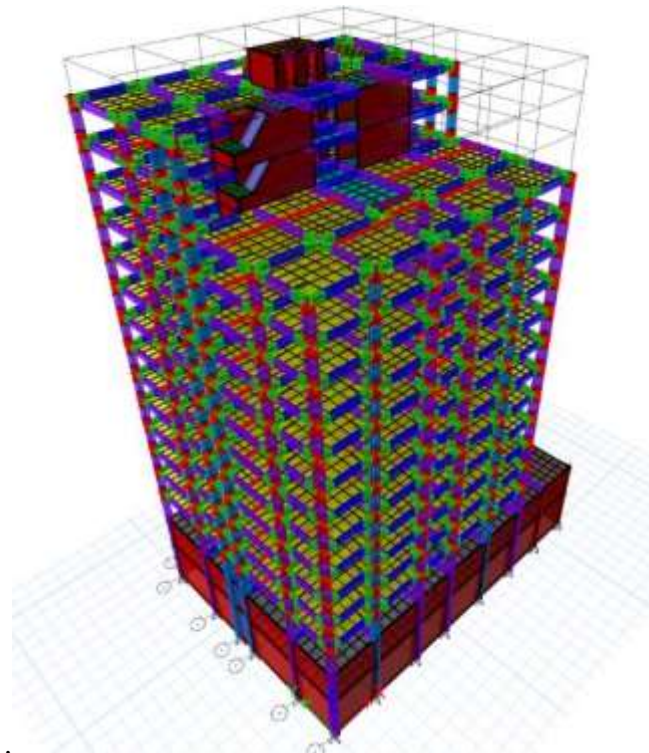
Modelo del Edificio de 14 pisos reforzado con perfiles metálicos H
